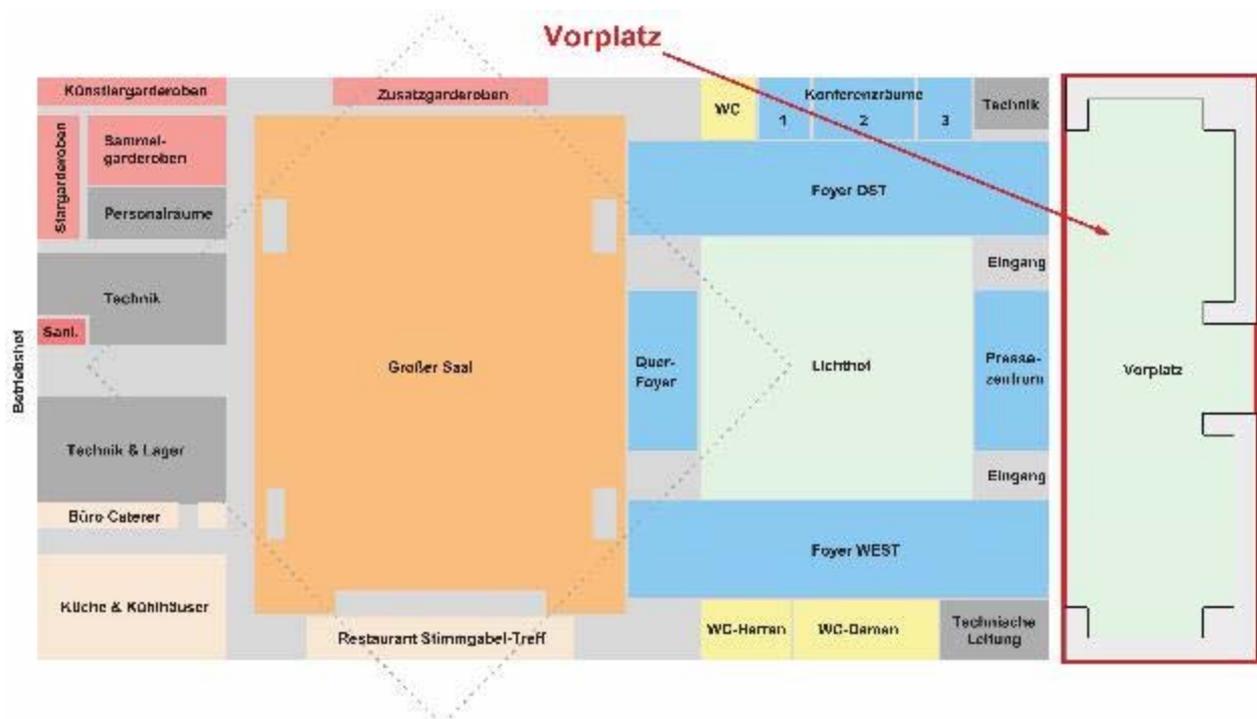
Der Vorplatz der FEH im Grundrissplan
